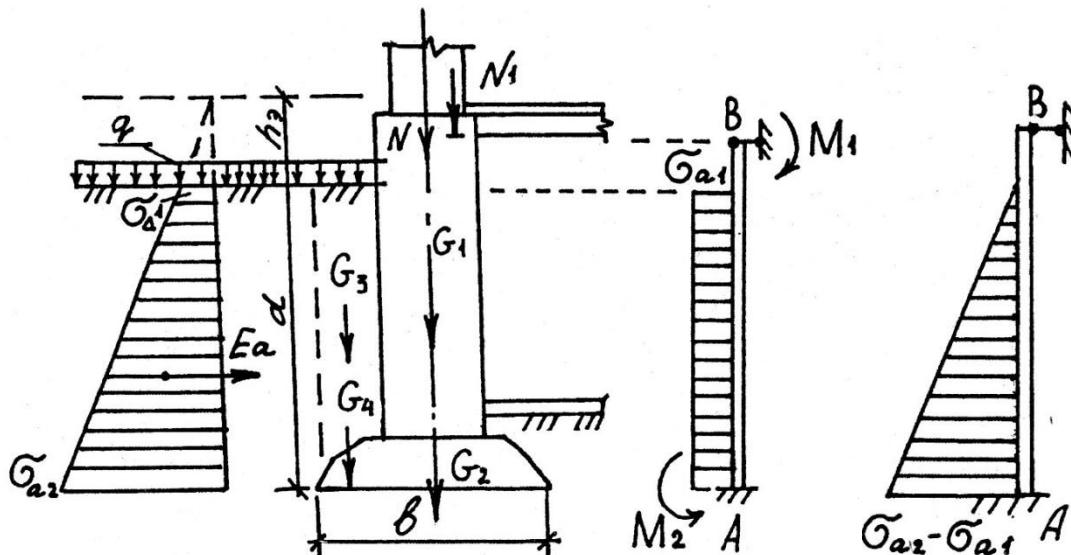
Расчетные схемы ленточного фундамента здания с подвалом
